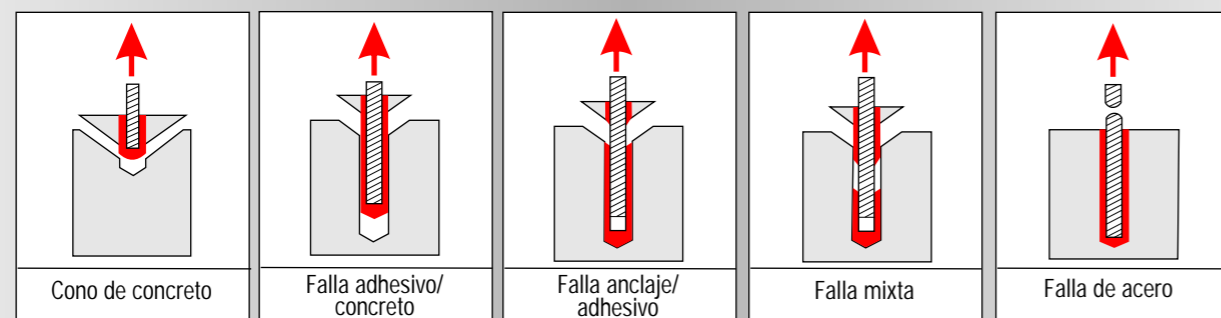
Modos de falla bajo cargas de tensión de sistemas de anclaje (Concreto sin fisuras)
